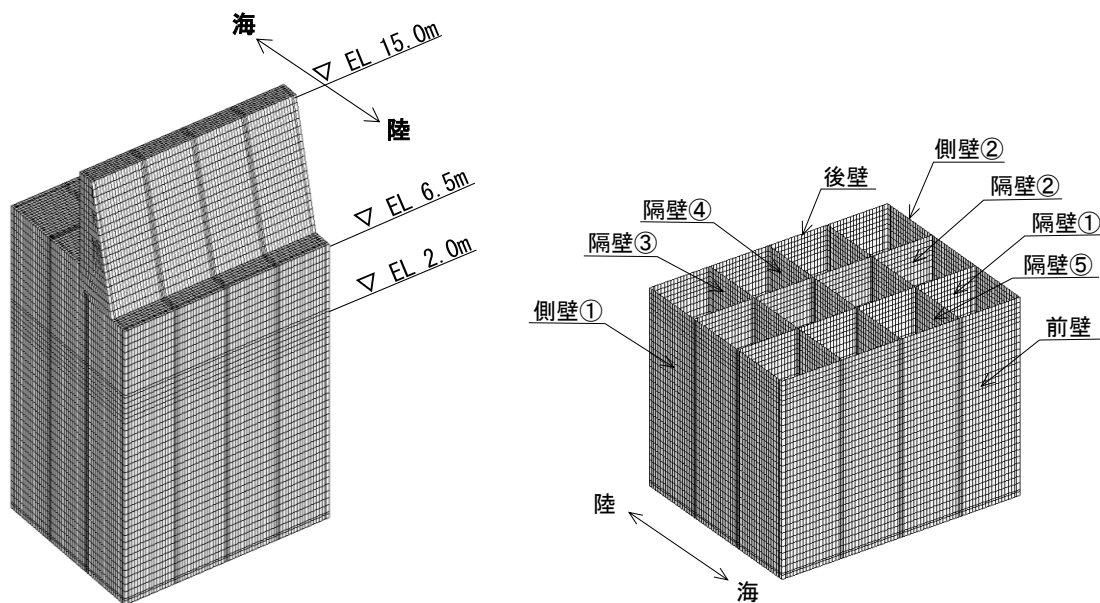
(2) 評価対象部材位置図 (④-④断面)
